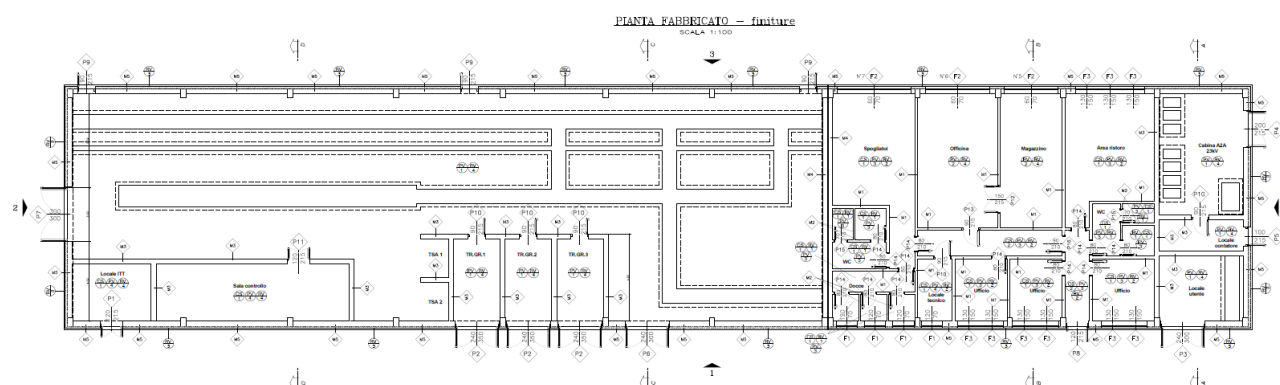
Planimetria SSE con indicazioni murature e finiture
